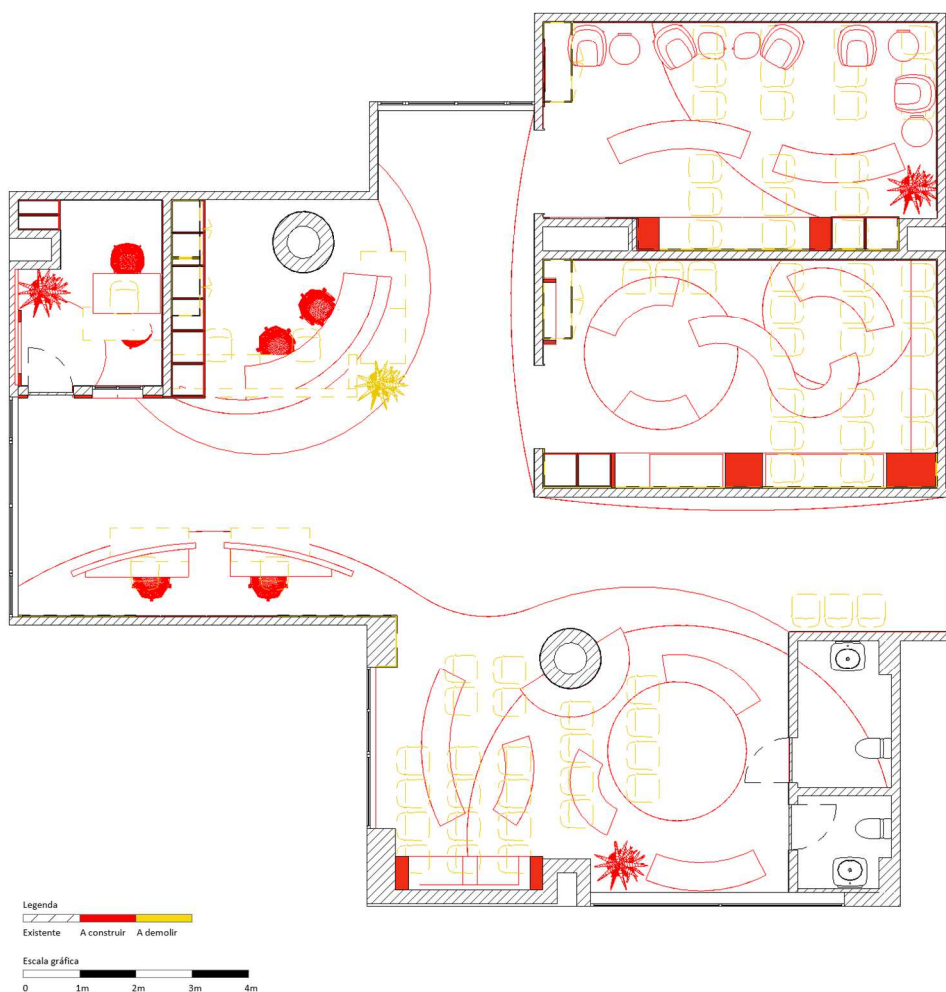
Desenho de projeto, Planta de Arquitetura de Alterações. Fonte: Autora.
